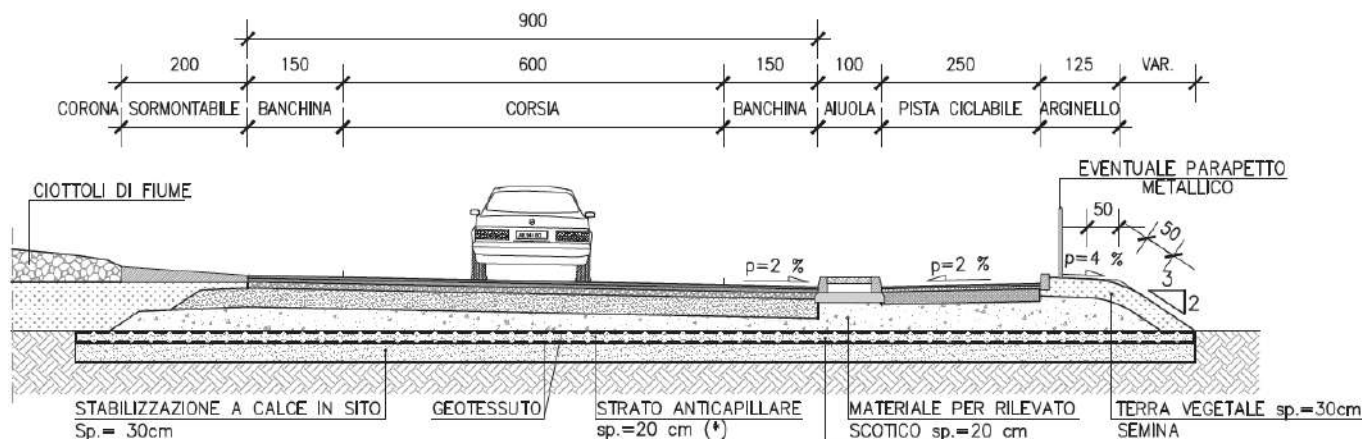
Sezione tipo in rotonda con pista ciclabile
